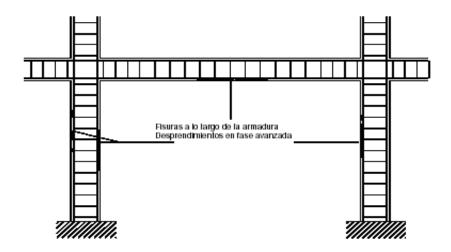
Fisuración por corrosión de las armaduras
